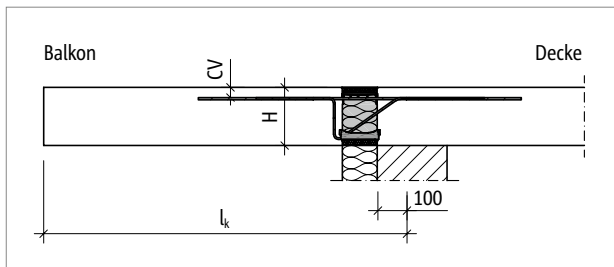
Schöck Isokorb® XT Typ KL-M1 bis M10: Statisches System
